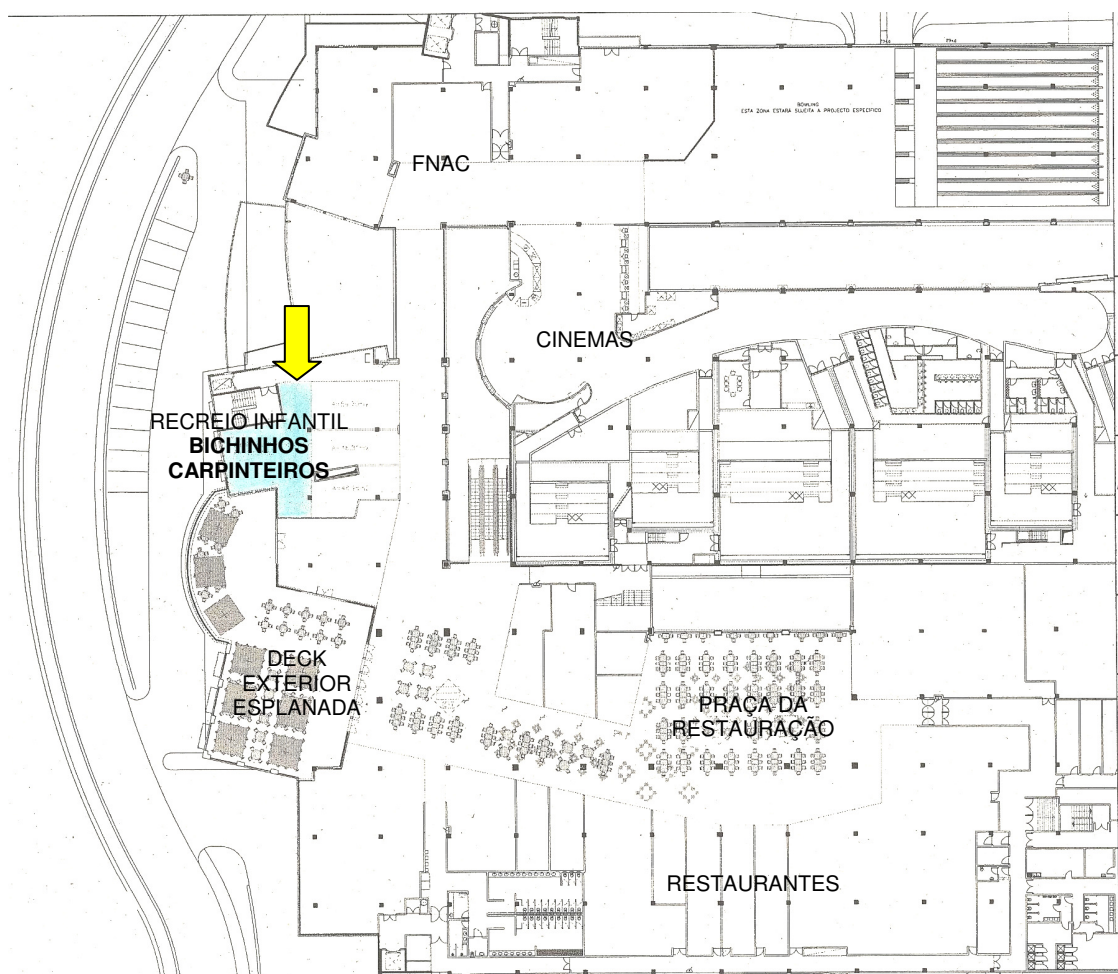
Planta da zona comercial do Piso 1 do MadeiraShopping
